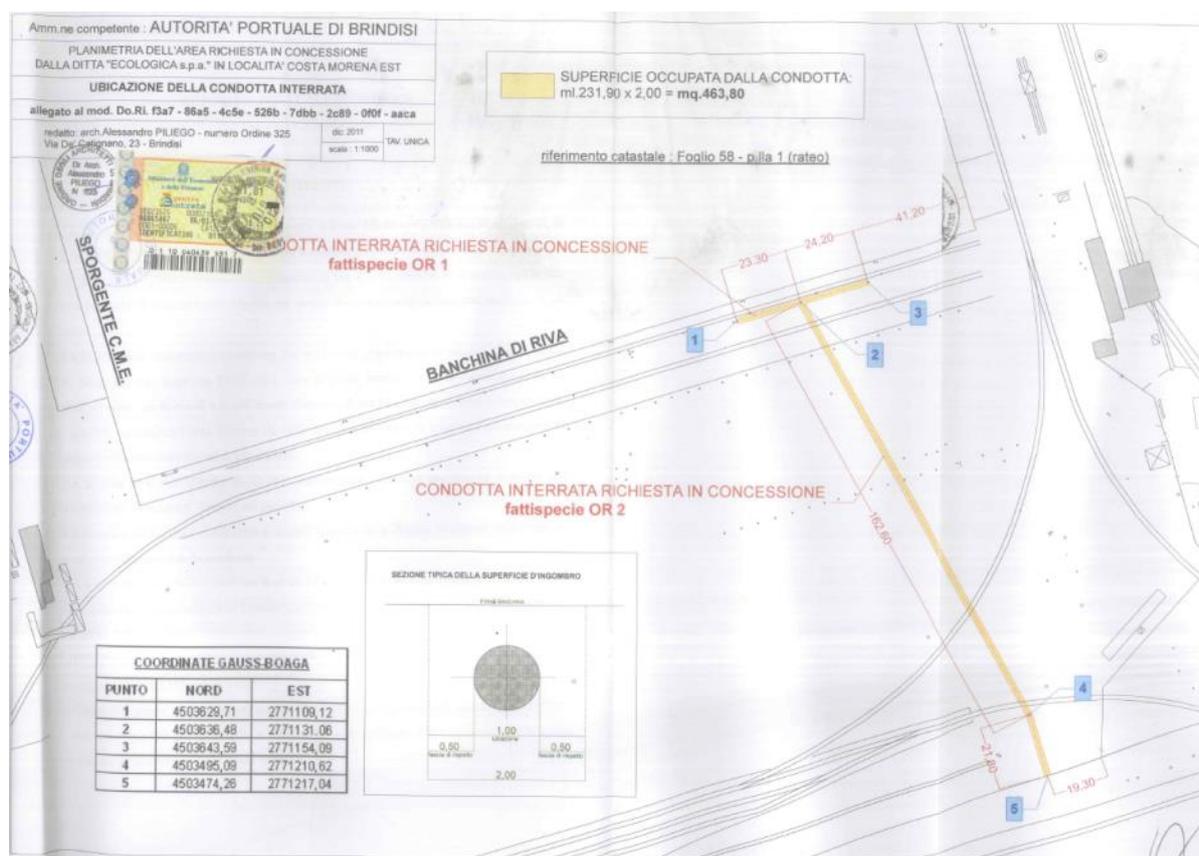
STRALCIO PLANIMETRICO CONDOTTA IN AREA DEMANIALE
